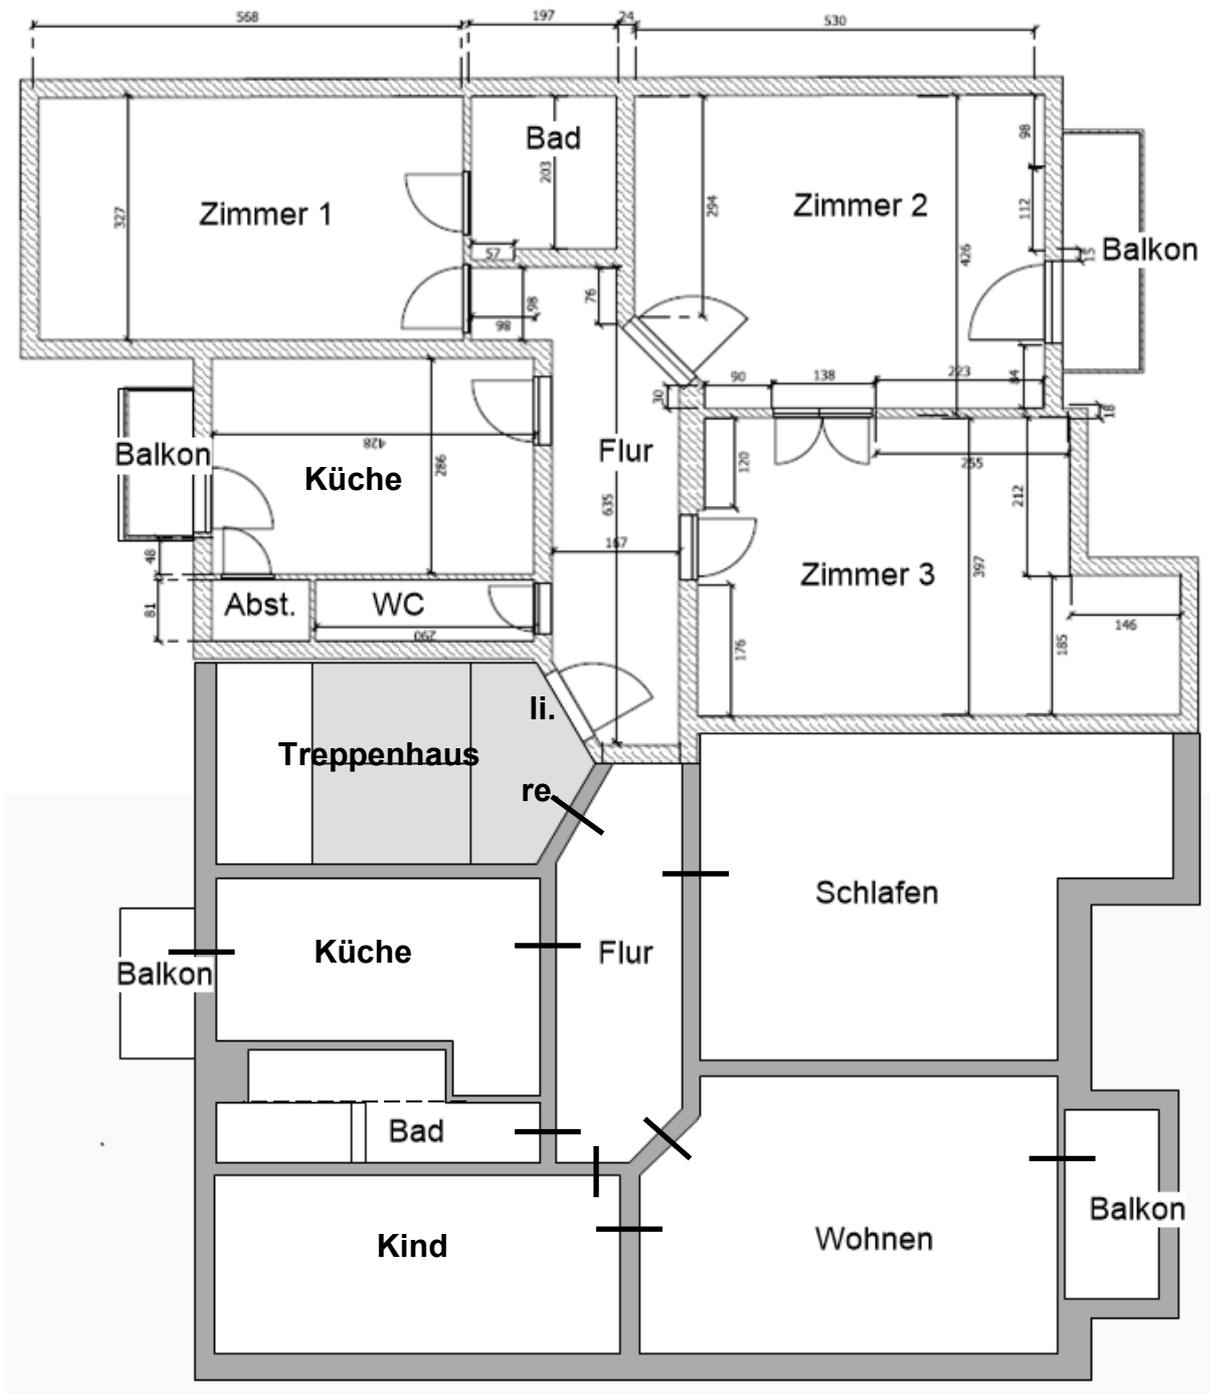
Grundriss 2. OG links (Quelle: Hausverwaltung) u. Grundrisskizze (ohne Maßstab) des SV (grob schematische Raumaufteilung); 2. OG rechts (ohne Nebengebäude und Garagen)
